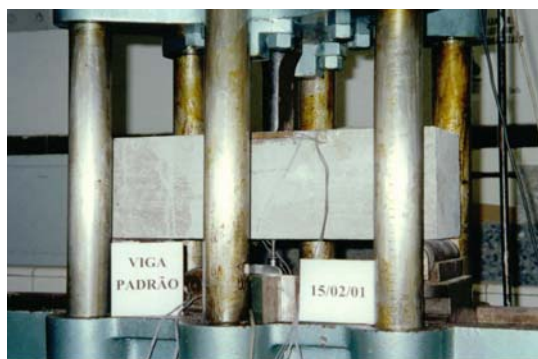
Esquema de Ensaio das Vigotas de Concreto Simples
